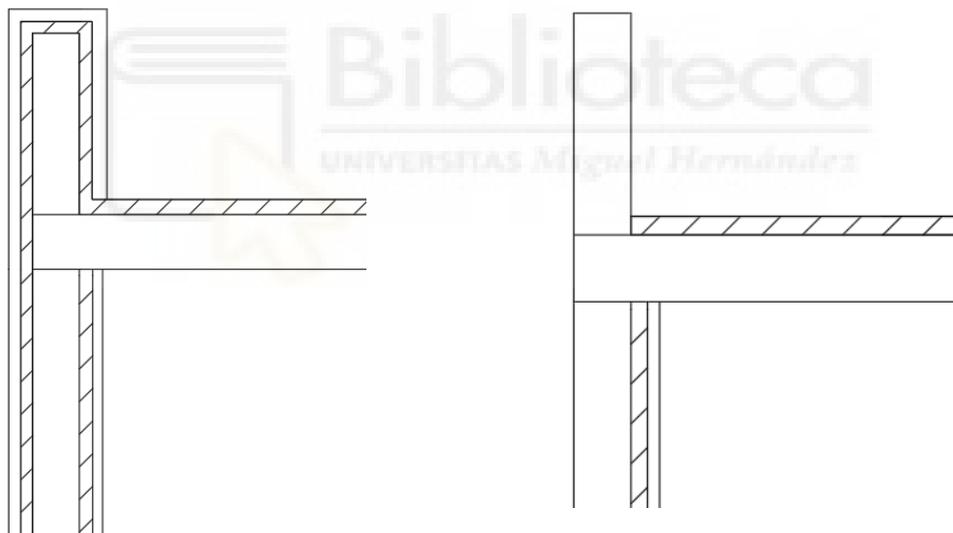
comparación de cubierta plana con SATE y cubierta plana con puente térmico
